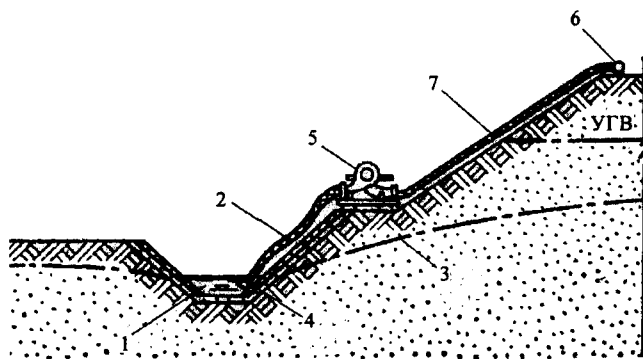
Схема открытого водоотлива в котловане ГЭС:
